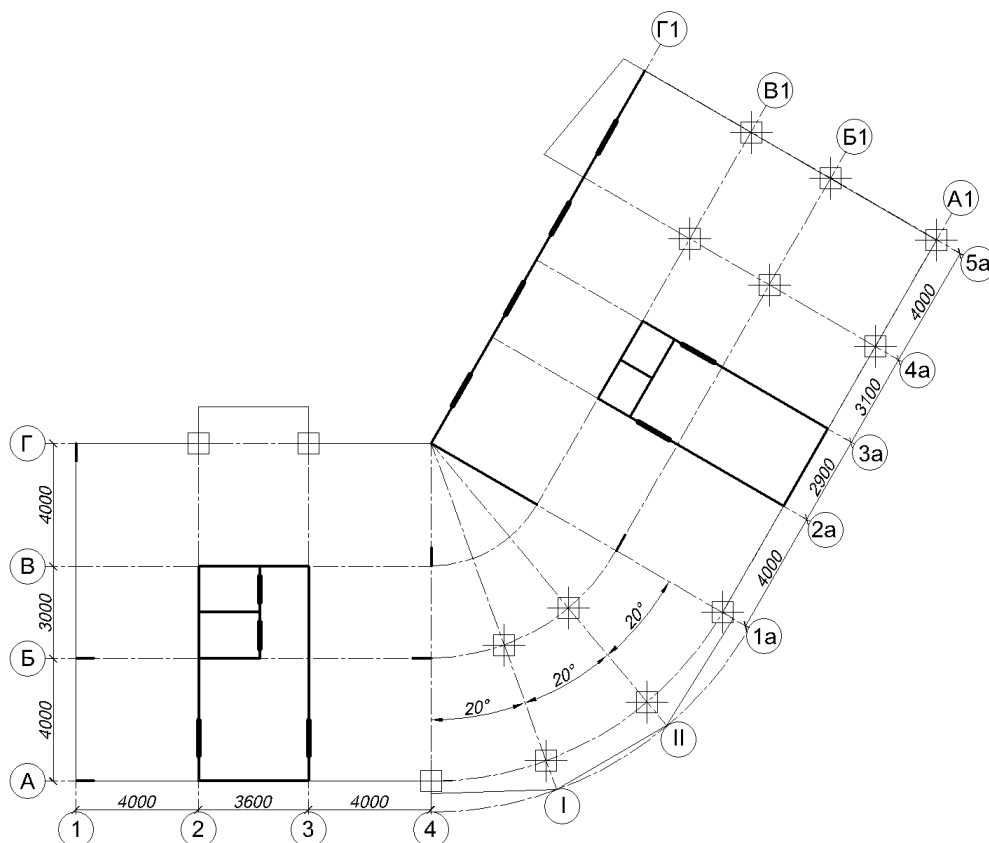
Плита перекрытия типового этажа (после корректировки)
